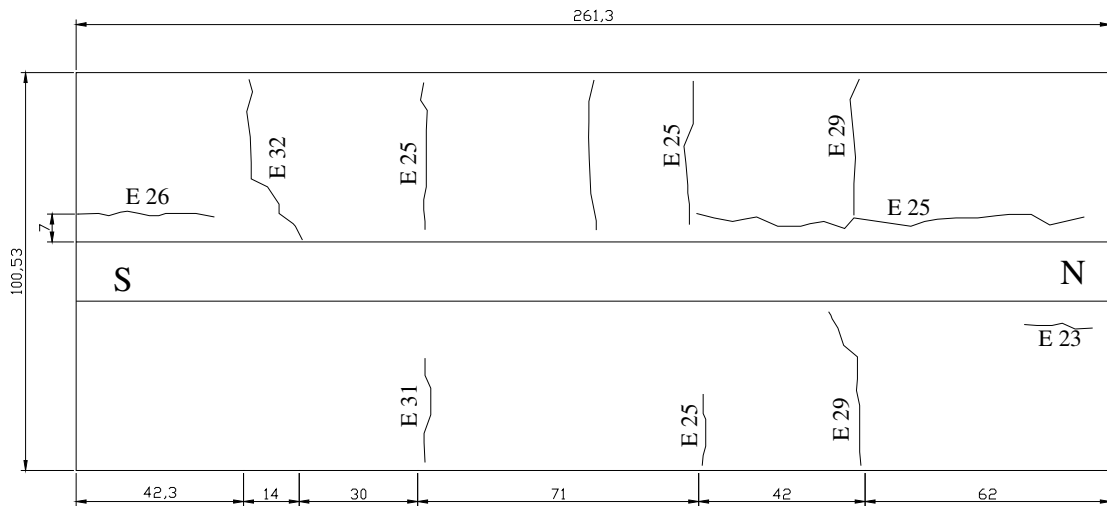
Fissuras do Modelo 3A (Face inferior da laje) – Medidas em cm.
